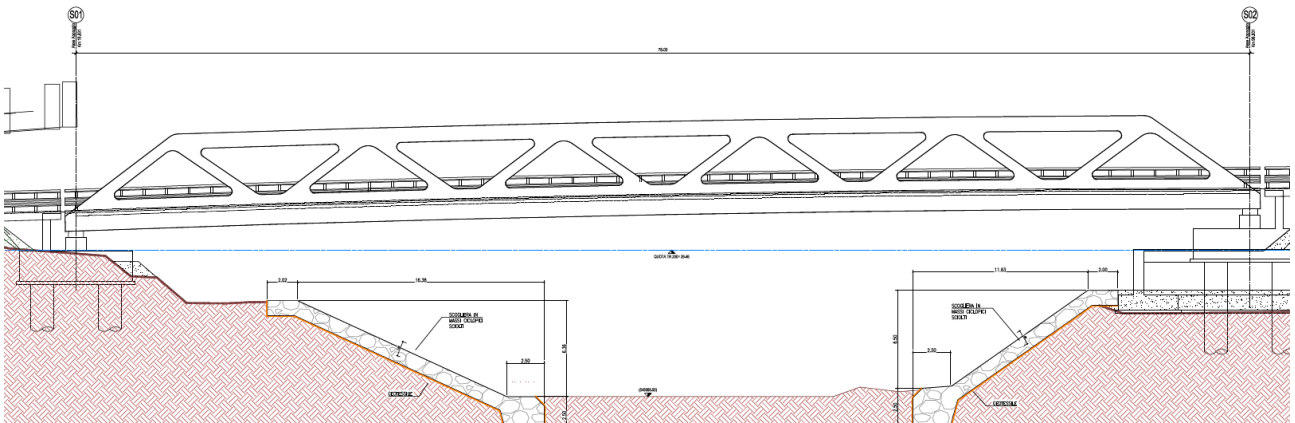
Prospetto del ponte di progetto della complanare lato monte
